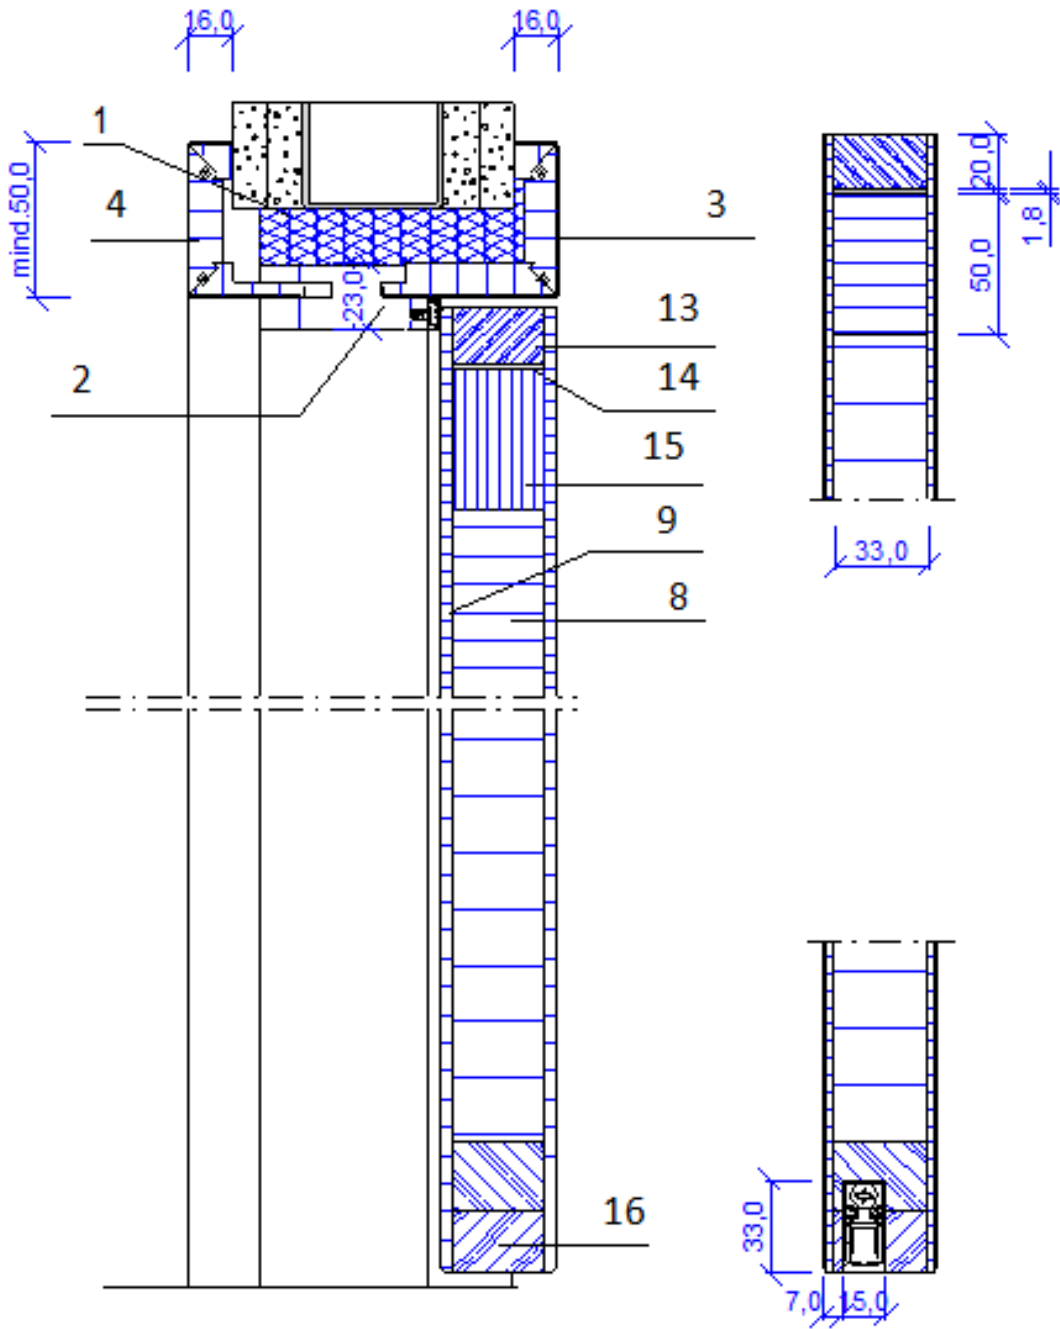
Verticale doorsnede – zonder bovenpaneel - Type A
